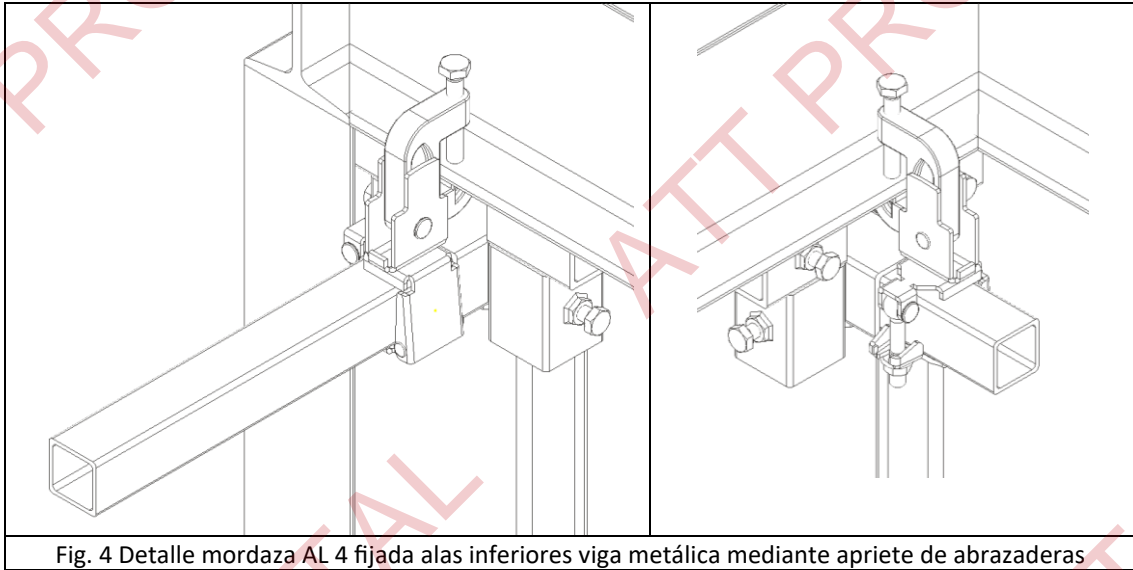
Detalle mordaza AL 4 fijada alas inferiores viga metálica mediante apriete de abrazaderas
